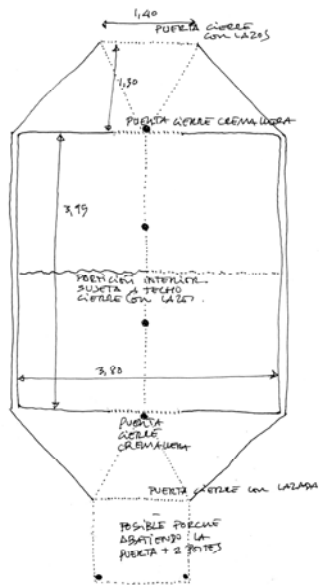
Croquis mostrando posibles ocupaciones en planta y sección de la Family Tent
